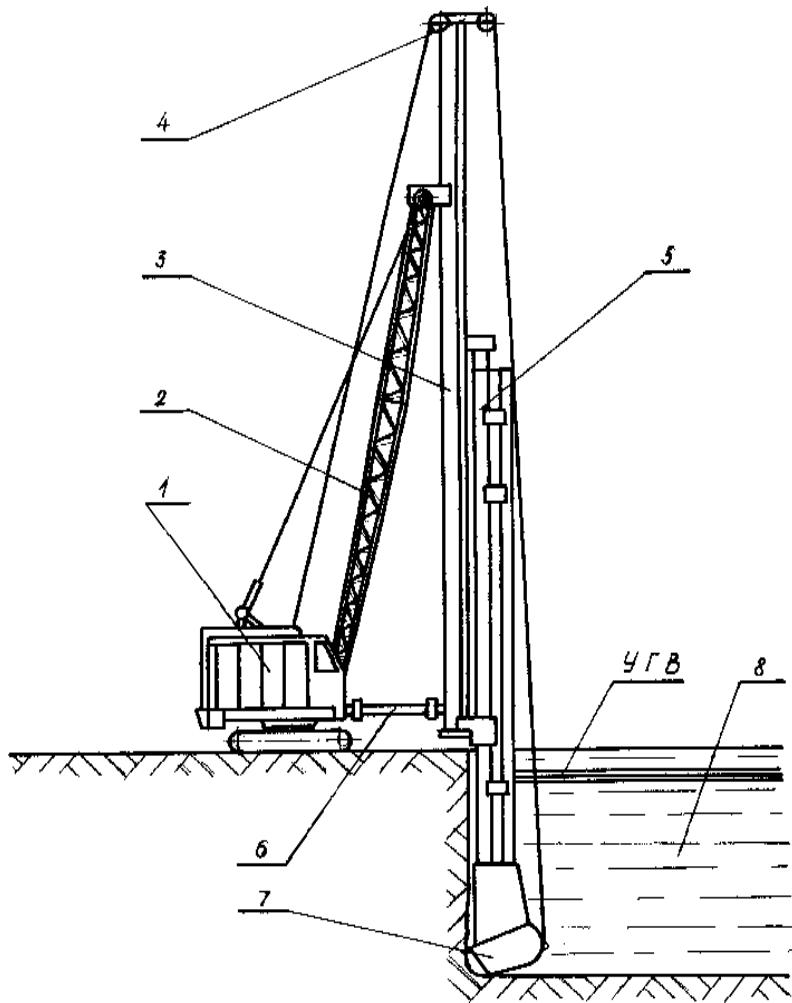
Штанговый экскаватор ЭК-600: 1 — базовая машина; 2 — стрела; 3 — копровая стойка; 4 — оголовок; 5 — рукоять; 6 — падающее устройство; 7 — ковш; 8 — разрабатываемая траншея
